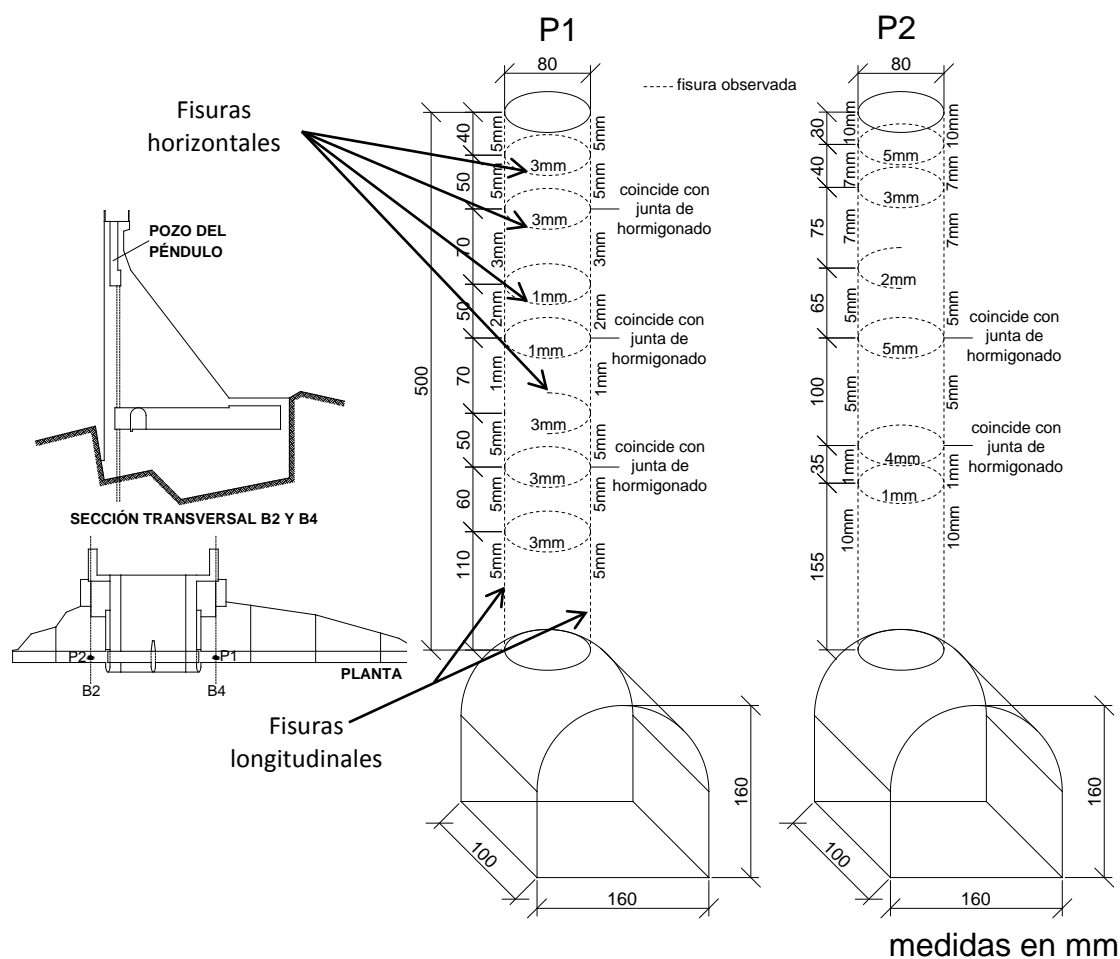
Levantamiento de fisuras en los pozos de los péndulos de Graus.
